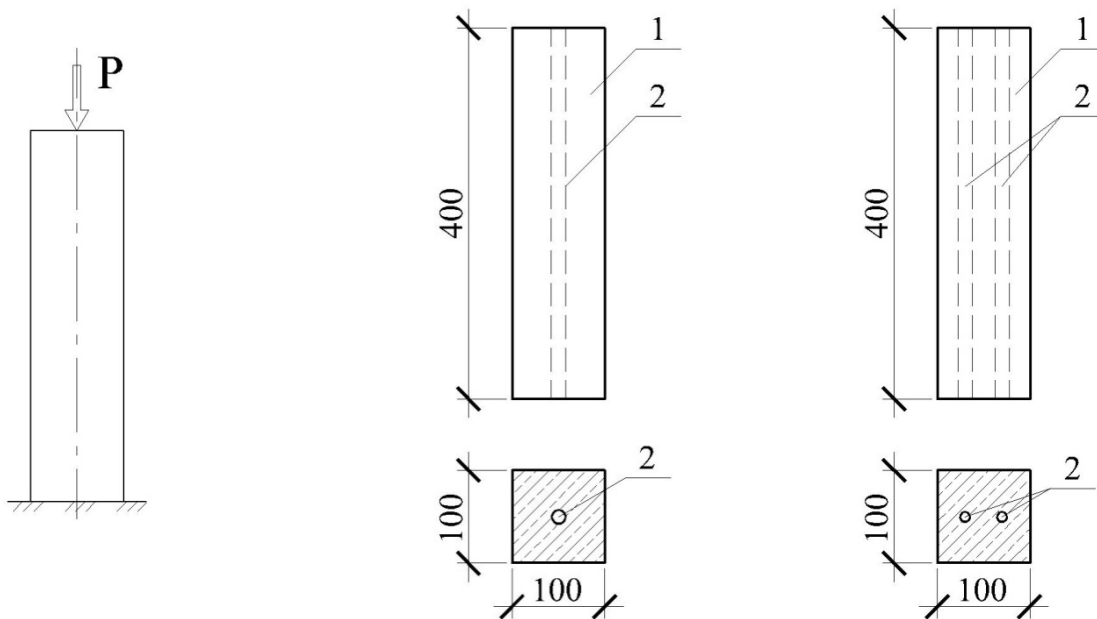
Схема випробувань (а) іконструкція дослідних зразків при розміщенні одного (б) і двох (в) стержнів арматури у поперечному перерізі; 1 – бетонна призма; 2 – стержень (стержні) композитної арматури
